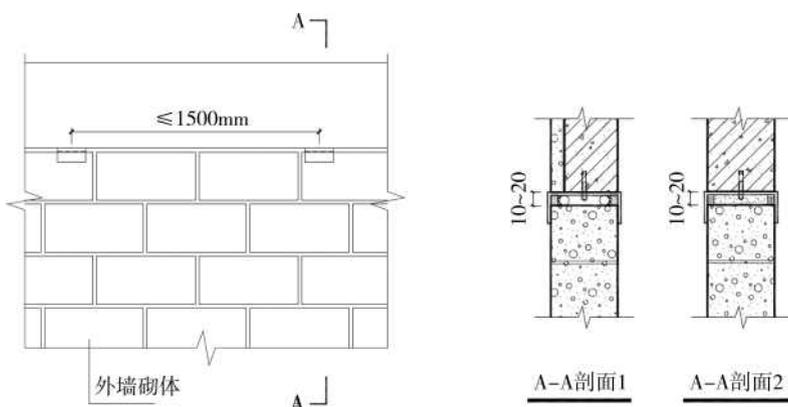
外墙砌体与钢筋混凝土梁的连接
